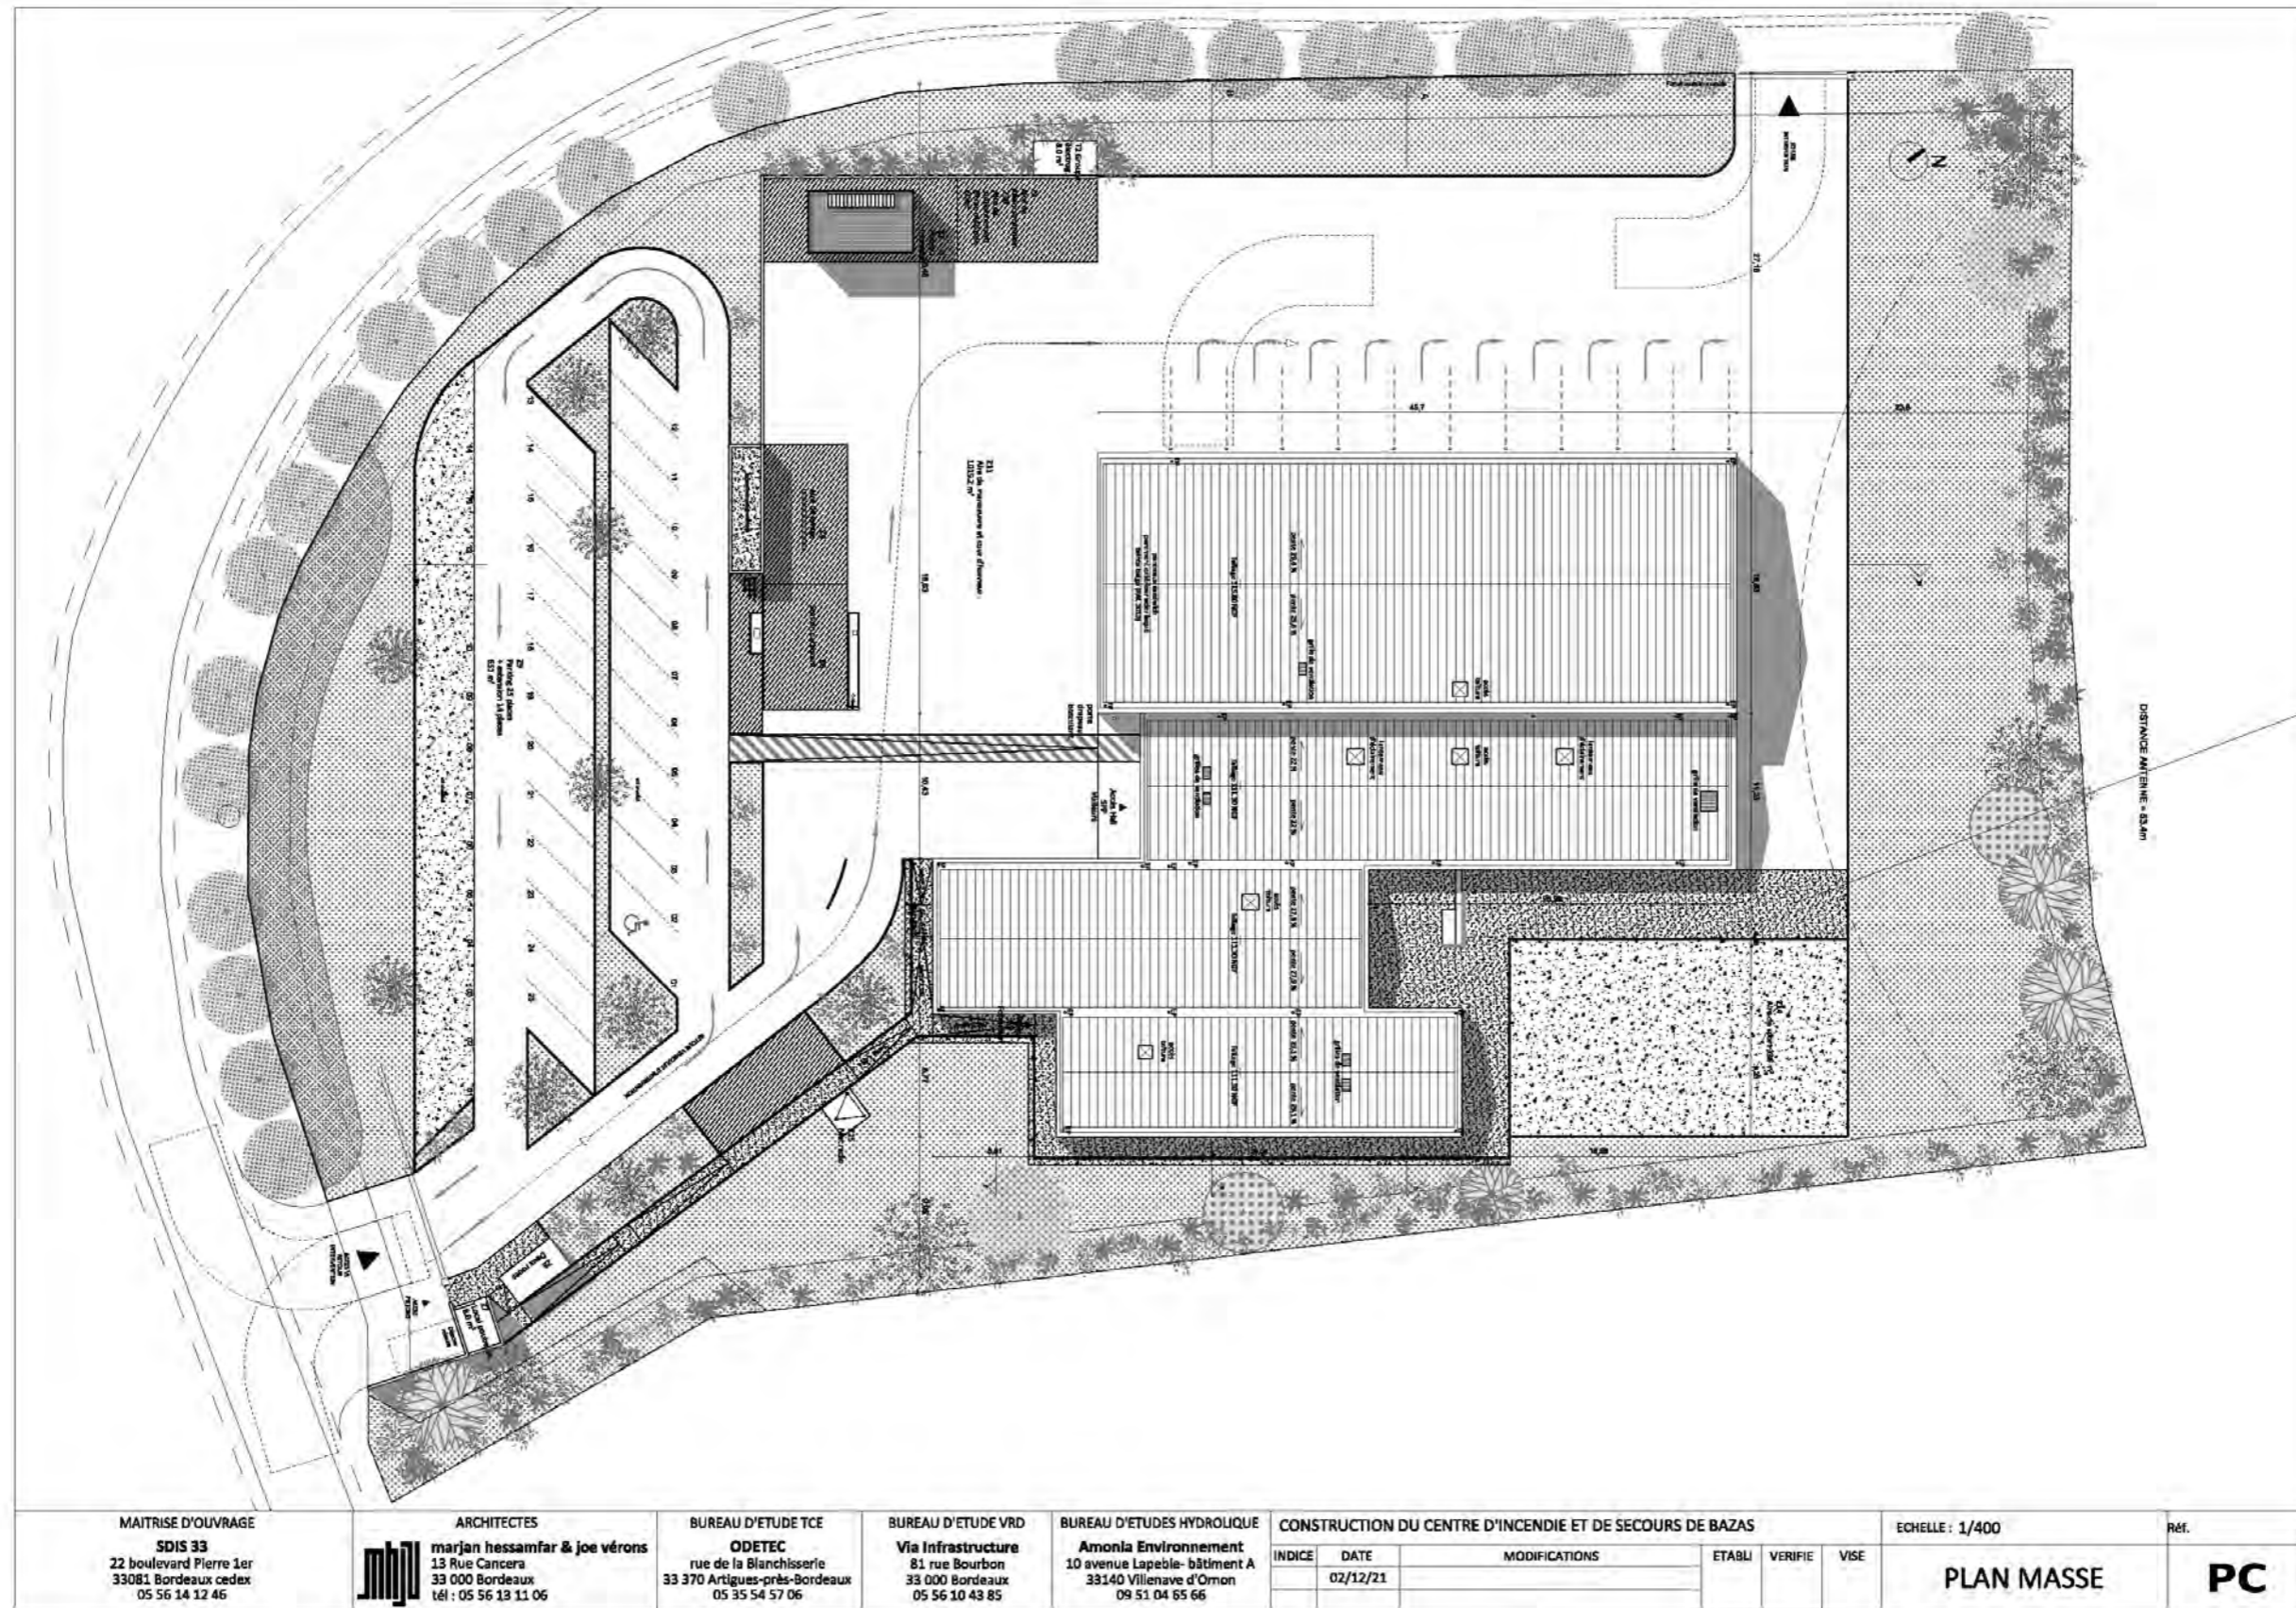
Permis de construire (PC) - Plan de masse (02/12/2021)
